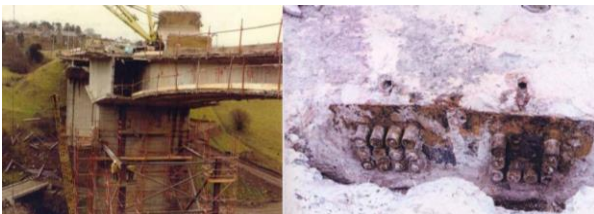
Vista general del puente durante el desmontaje (izquierda) y detalle de placas de anclaje con claros síntomas de corrosión [3].
